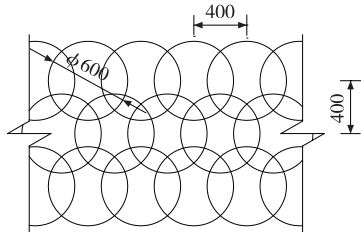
基坑止水旋喷桩平面布置示意图(单位:mm)
